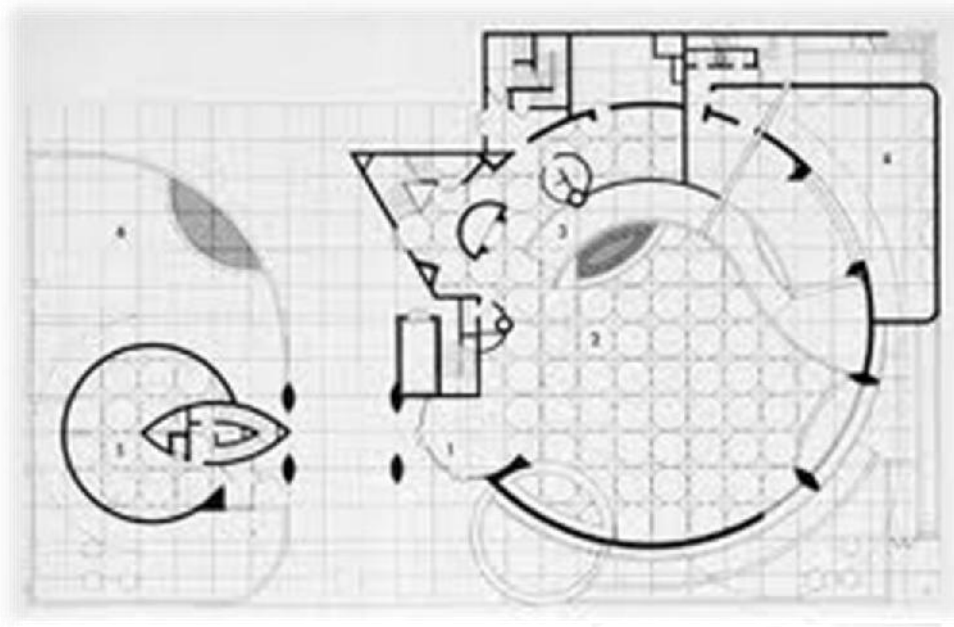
, Planta Arquitectónica Museo Solomon R. Guggenheim.
